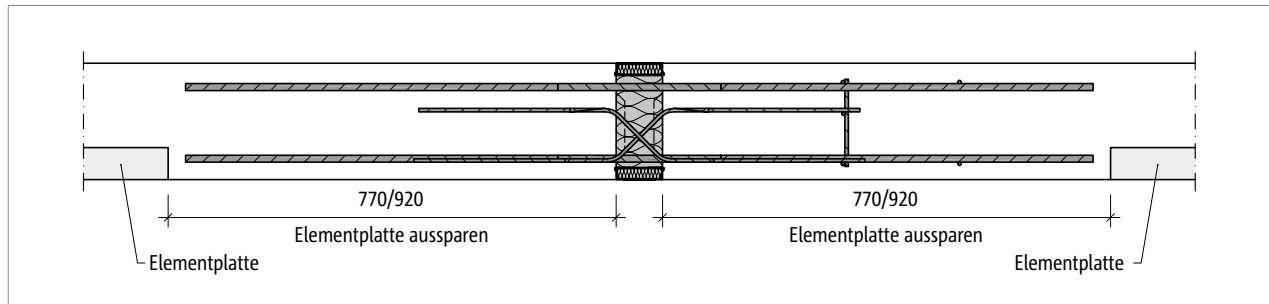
Schöck Isokorb® T Typ DP: Aussparte Elementdecke mit eingesetztem Isokorb® T Typ DP
